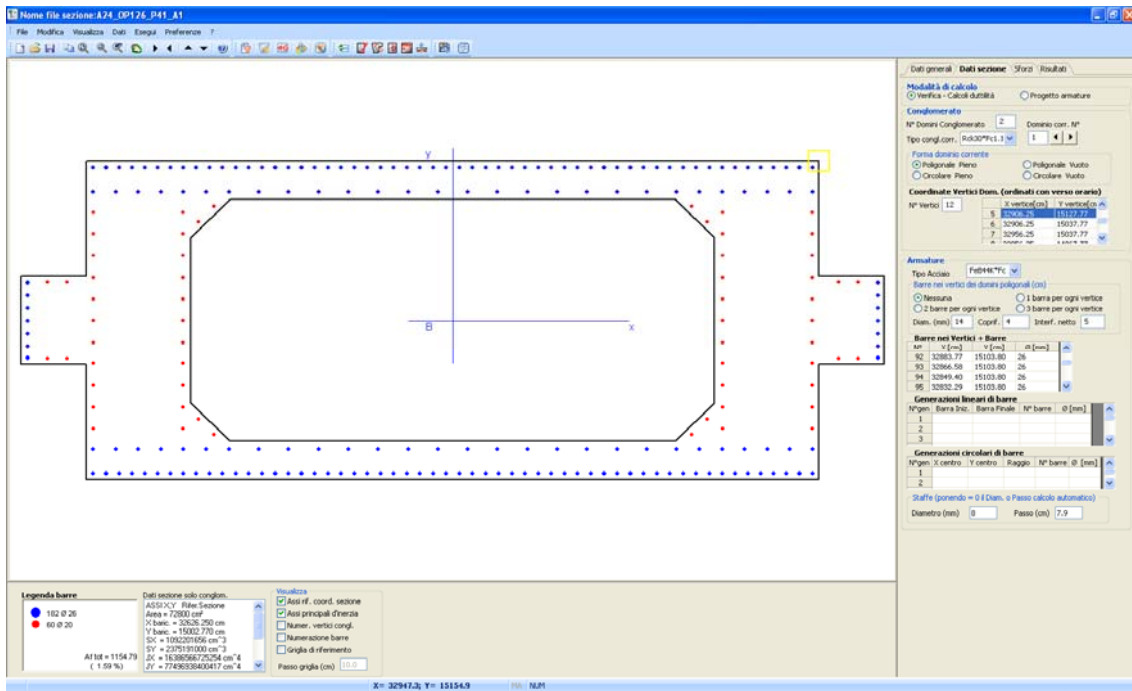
Armatura longitudinale di sezione 2 (182Φ26+60Φ20);
